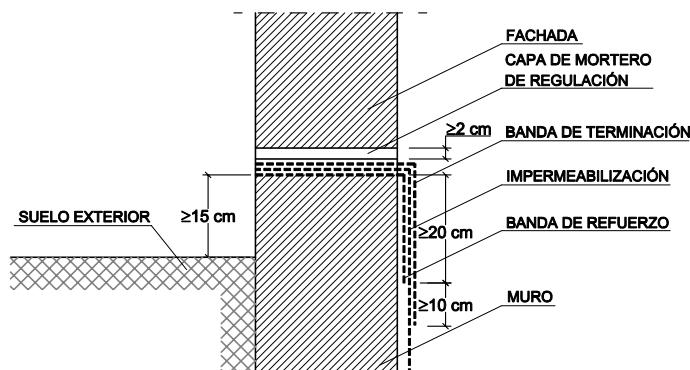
Ejemplo de encuentro de un muro impermeabilizado por el interior con lámina con una fachada
